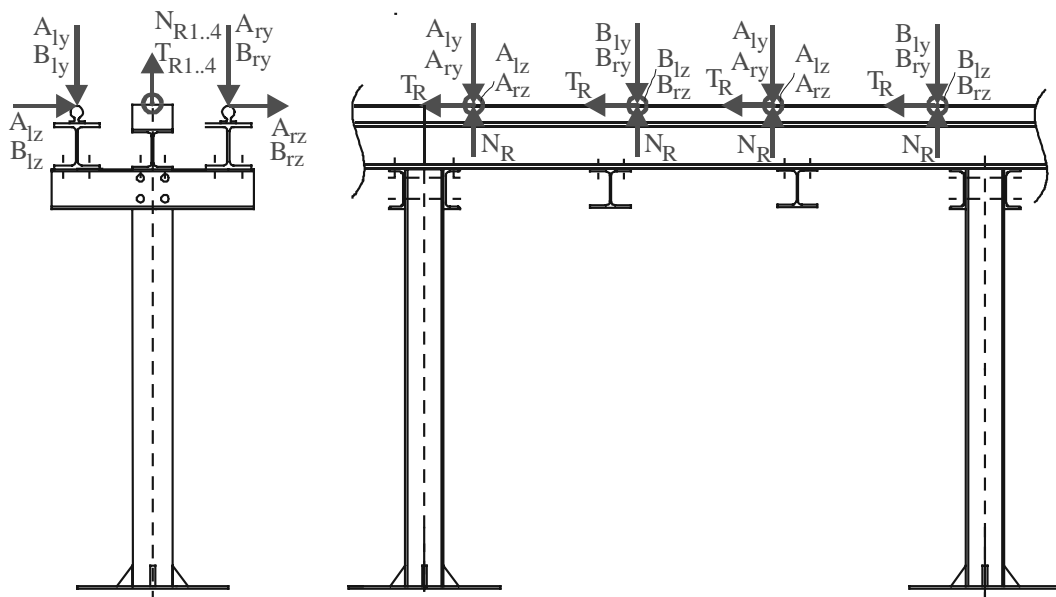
Detailplanung der Streckenkonstruktion (Stahlkonstruktion)
